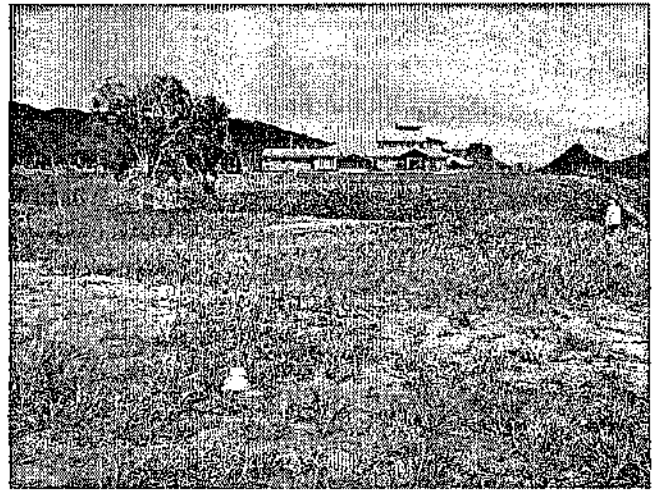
Lote 23/SC - Recuperação Vegetal do Canteiro de Obras - Ivaí
